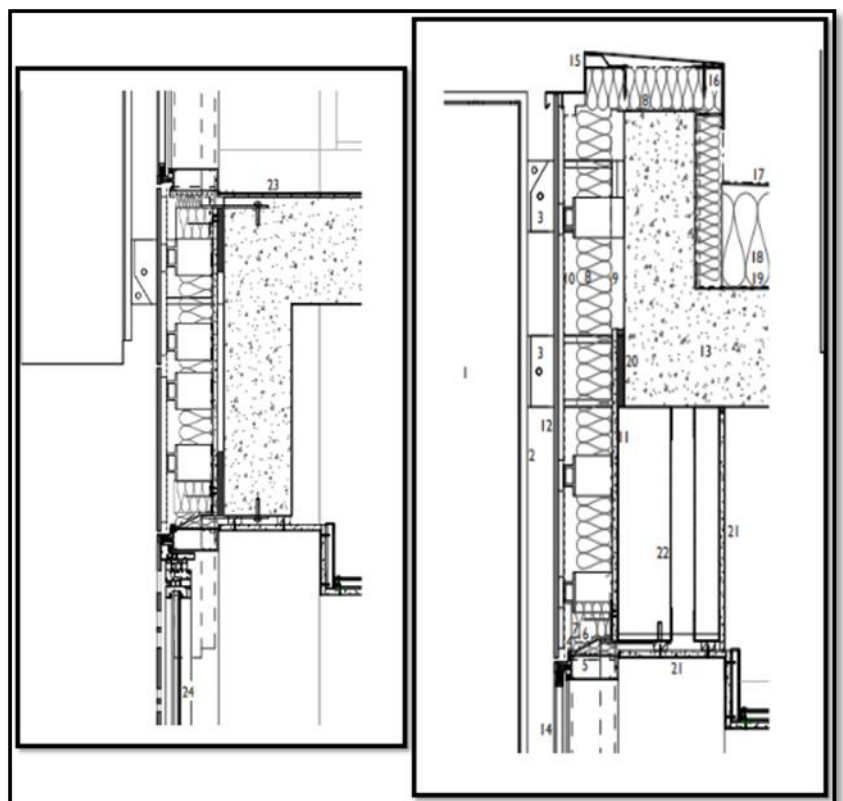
photo qui représente une coupe au niveau de mur la source : archdaily(<https://www.archdaily.com>)
